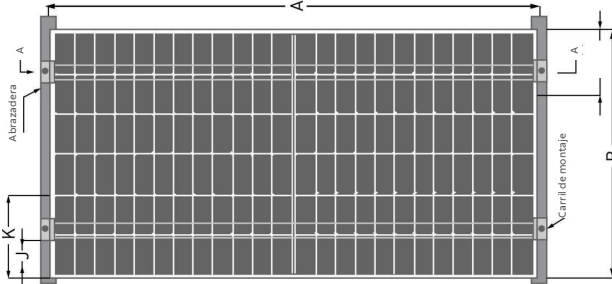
Instalación de abrazaderas en el lado corto de las estructuras
